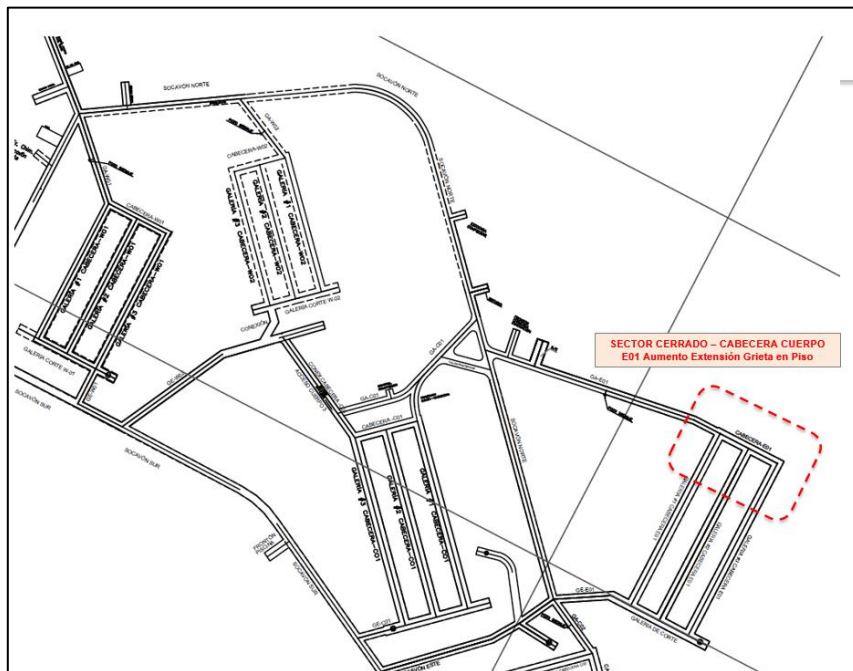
Imagen en planta con ubicación cuerpo E01 y zona cerrada producto de daño y agrietamiento en piso de la galería cabecera.
